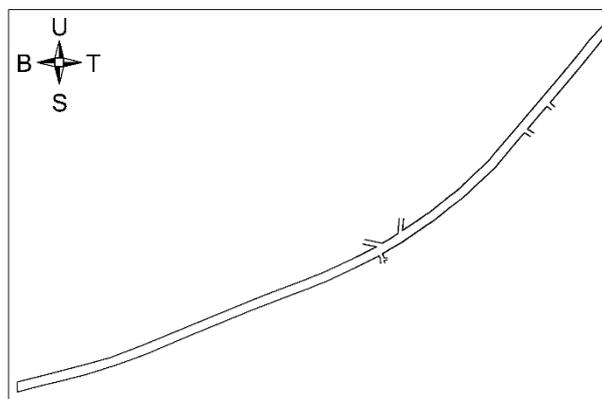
Site plan* keseluruhan ruas jalan
